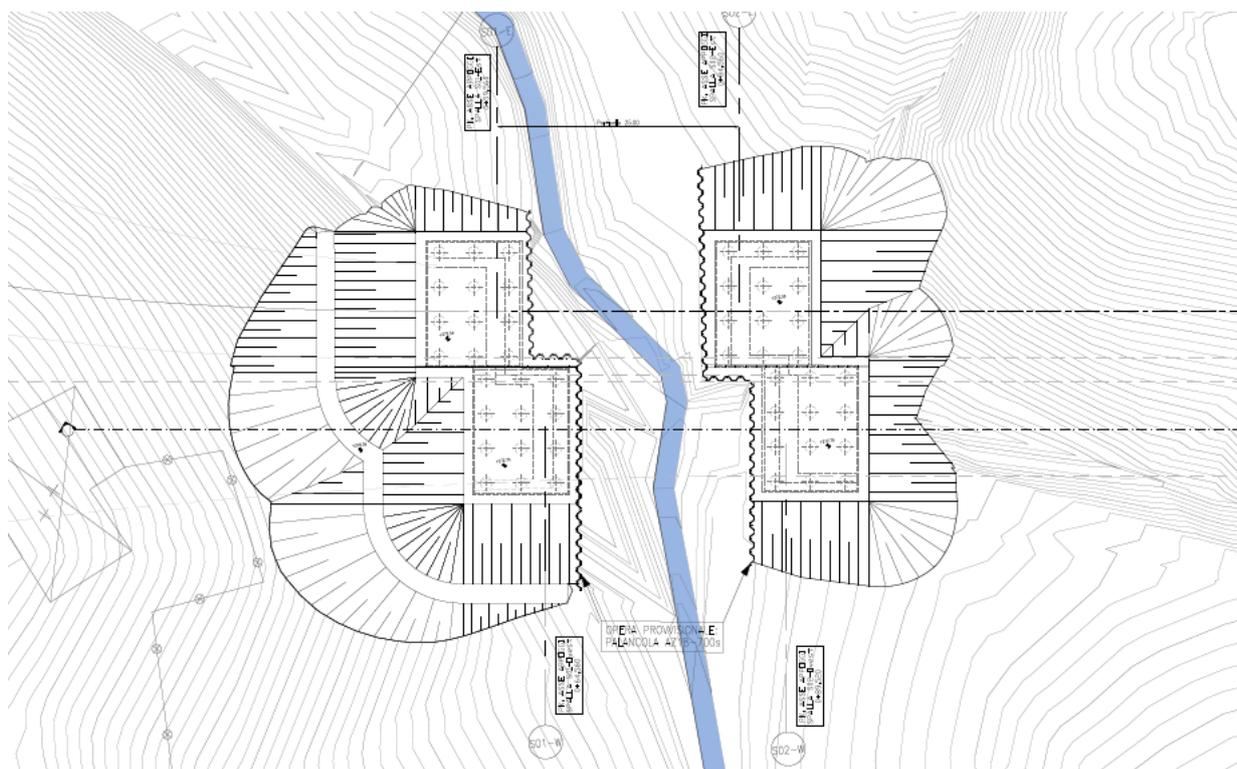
Pianta scavi e palancole provvisorie fronte canale
